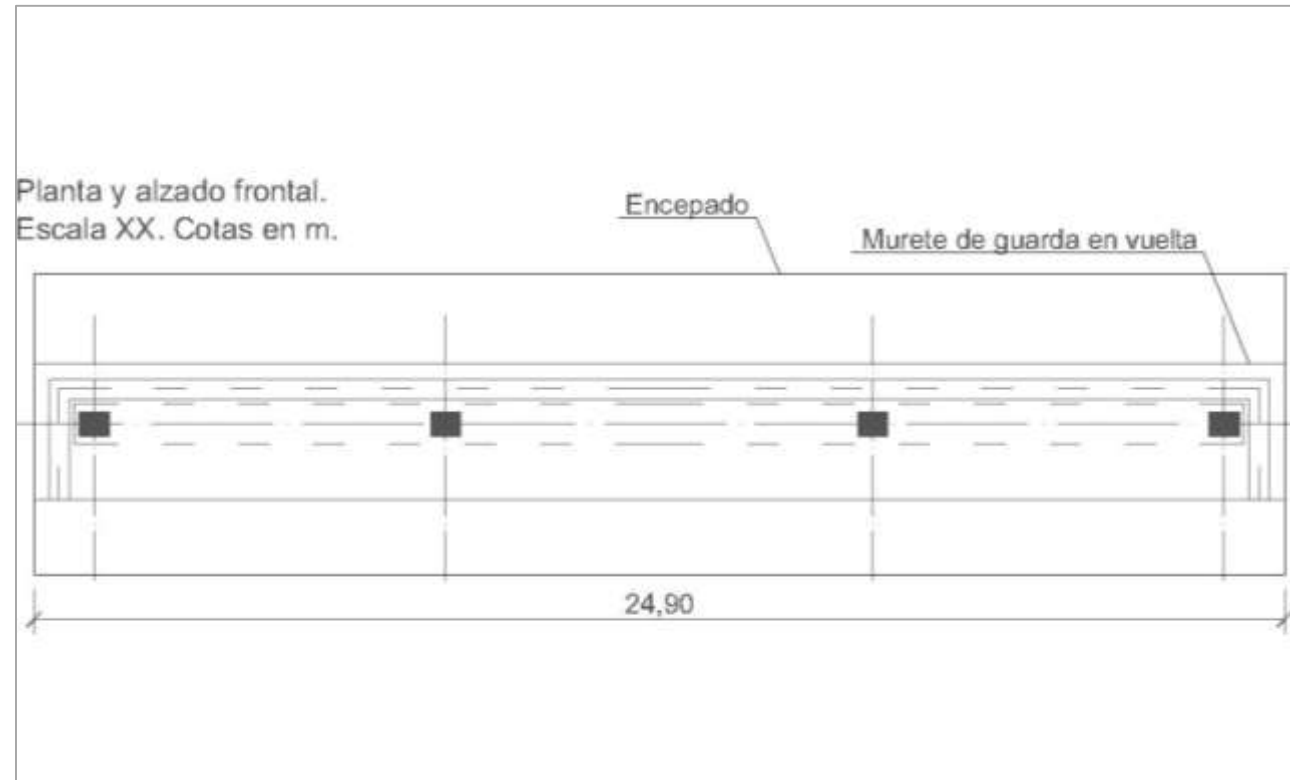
Planta de ambos estribos. Fuente: Elaboración propia con AutoCAD.
